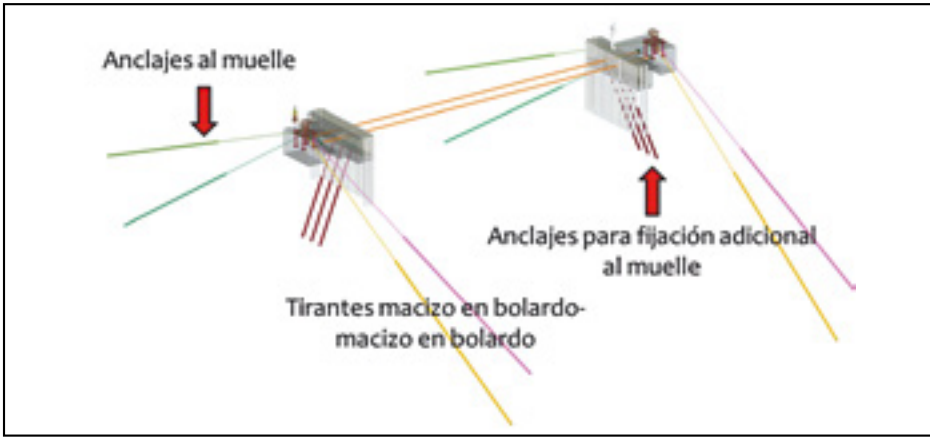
Vigas cantil enfrentadas ancladas entre ellas con fijación adicional al muelle mediante anclajes.
